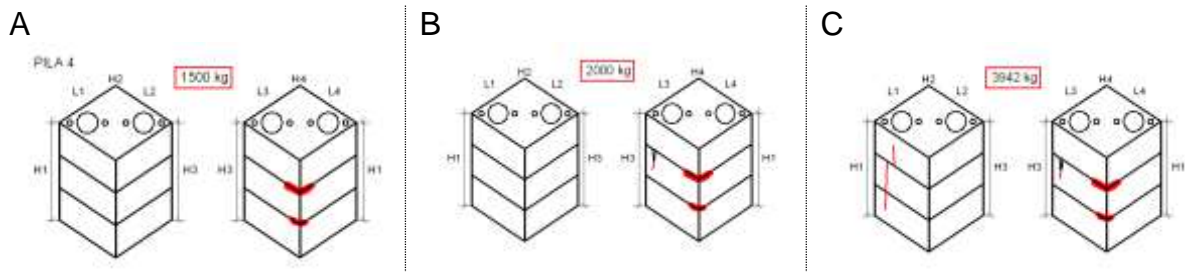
Evolución de grietas en pilas sin juntas de mortero, con vista posterior y anterior respectivamente.
